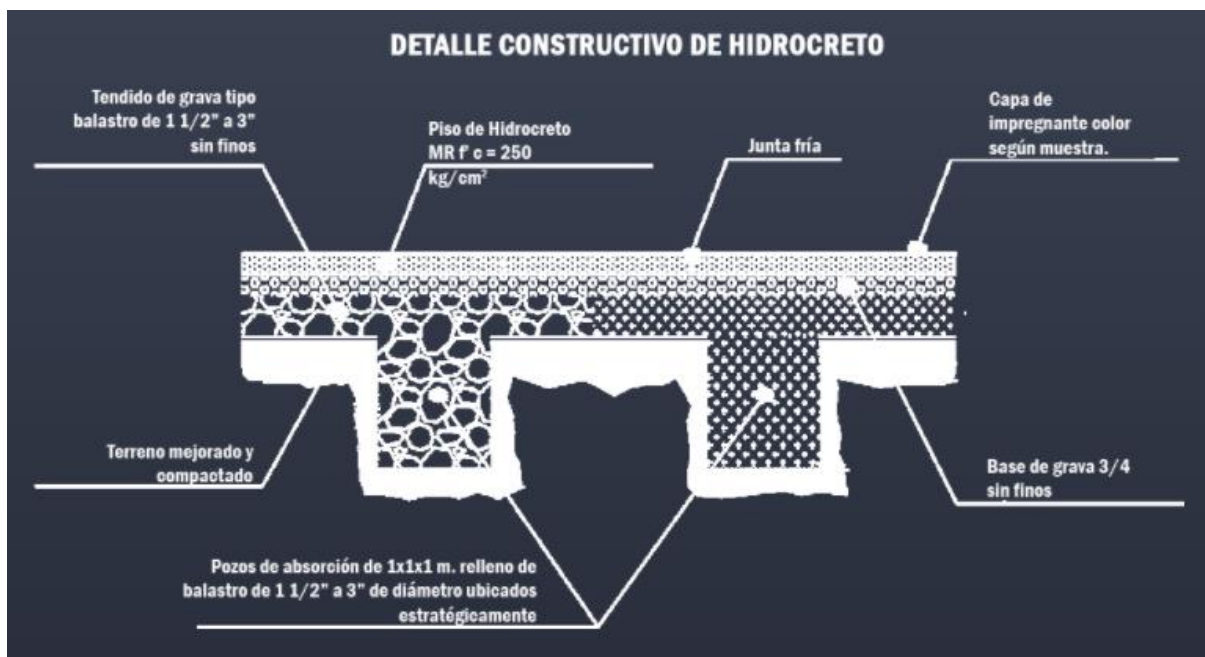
Detalle constructivo de concreto permeable Hidrocreto. (ECOHIIDROCRETO, 2021)
